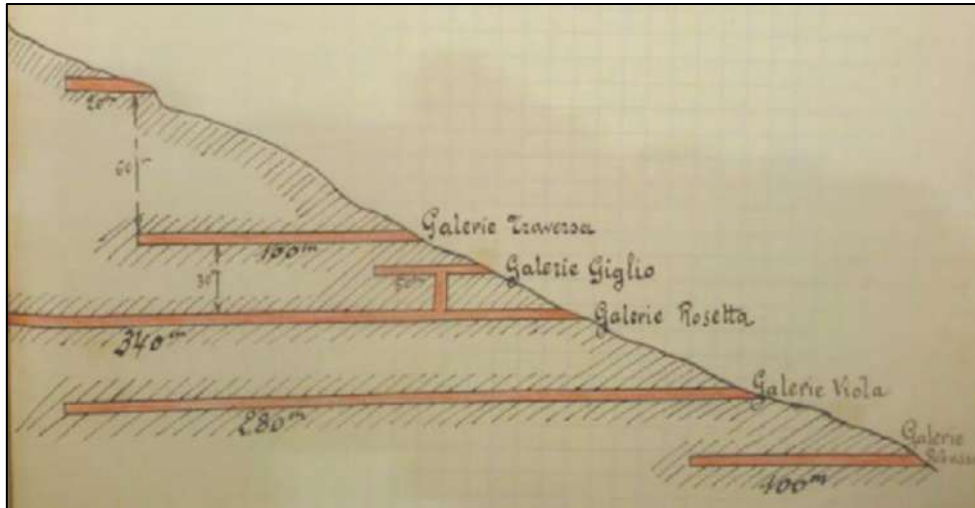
Coupe des travaux du secteur de Spergane (Luri)
